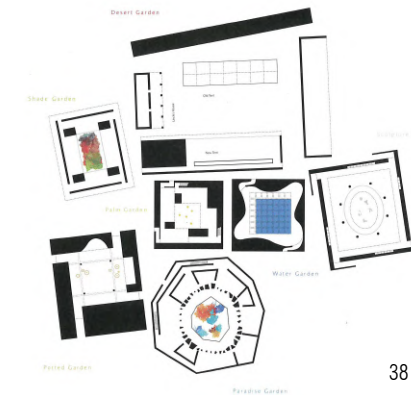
Peter Zumthor, boceto de planta para House of Seven Gardens, Doha, Catar (desde 2009)
